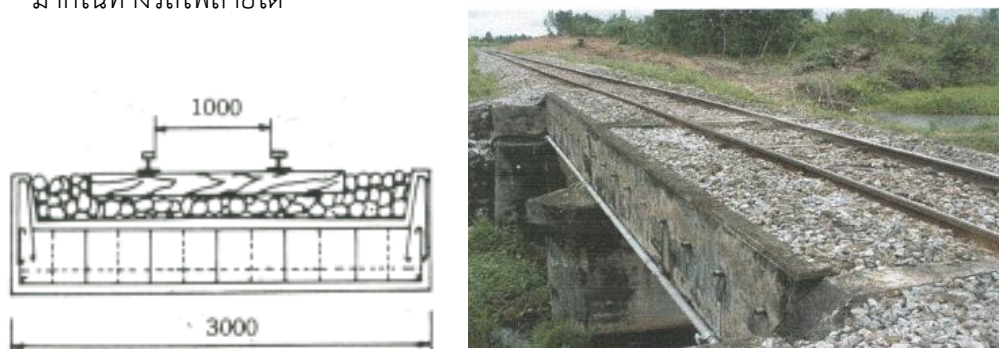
สะพาน Viaduct Bridge
